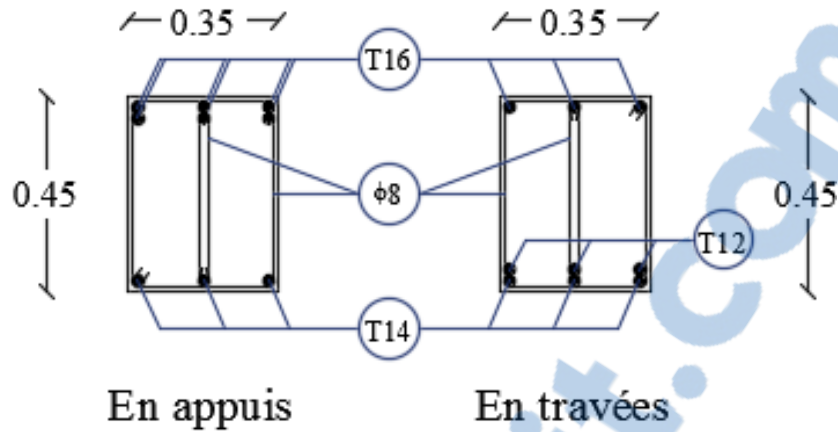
Ferrailage des poutres principales (bloc A1 & A2)
